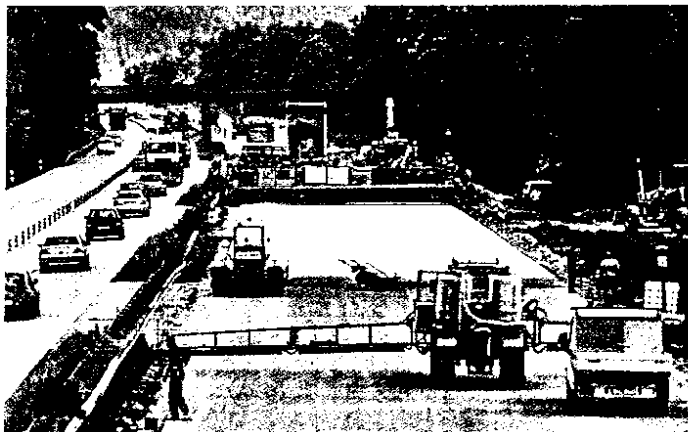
Herstellung einer Betonfahrbahndecke mit „Österreichischer Waschbetonoberfläche“: Betoneinbau mit Gleitschalungsfertiger, Aufsprühen eines kombinierten Verzögerungs- und Nachbehandlungsmittels von einer Arbeitsbühne aus (helle Färbung), Abbürsten des nicht erhärteten Oberflächenmörtels und Aufsprühen eines herkömmlichen Nachbehandlungsmittels von einem separaten Trägergerät aus.
